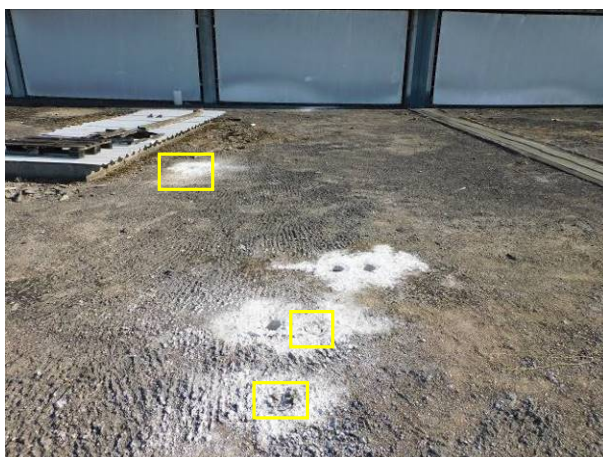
Idem. Piso 5. Zona Z(5).1, com deteção da malha de armaduras na face superior da laje, com recurso ao equipamento detetor de armaduras (pacómetro), para extração de três carotes (designadas de C20, C21 e C22) destinadas a ensaios laboratoriais (ensaios de compressão). Presença de orifícios (assinalados a amarelo) em que a tentativa de extração de carotes foi mal sucedida, devido aos comprimentos insuficientes para ensaio laboratorial.
